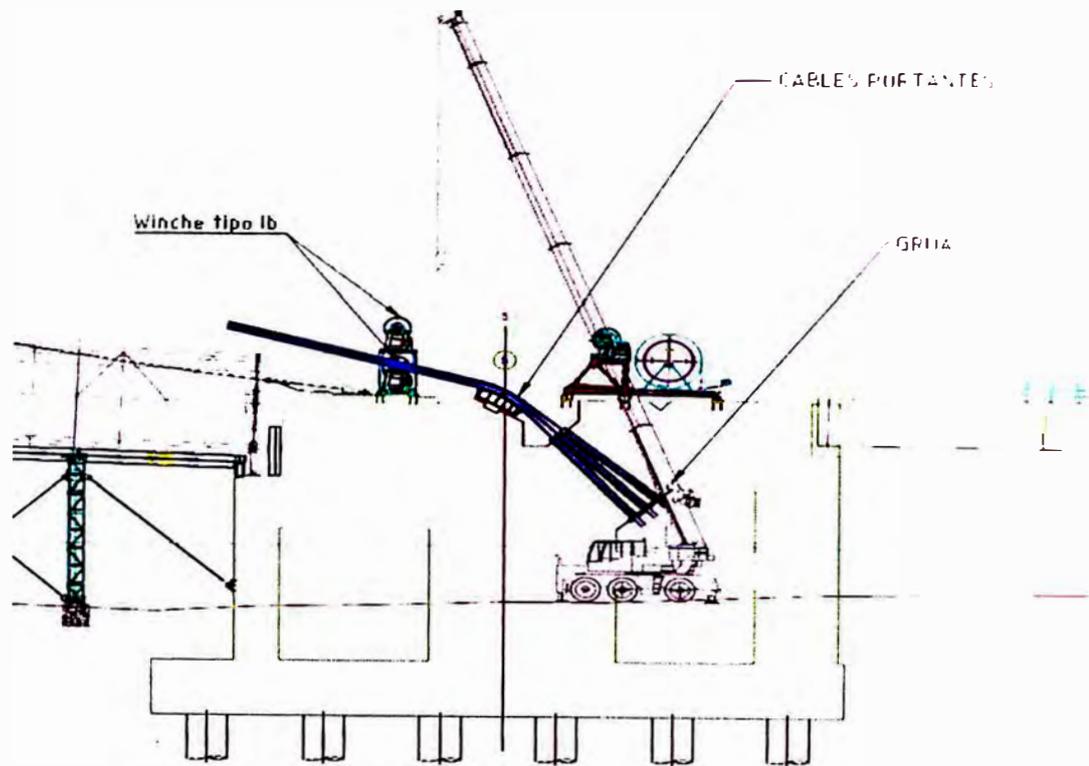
ANCLAJE DE CABLE PORTANTE EN CÁMARA DE ANCLAJE
